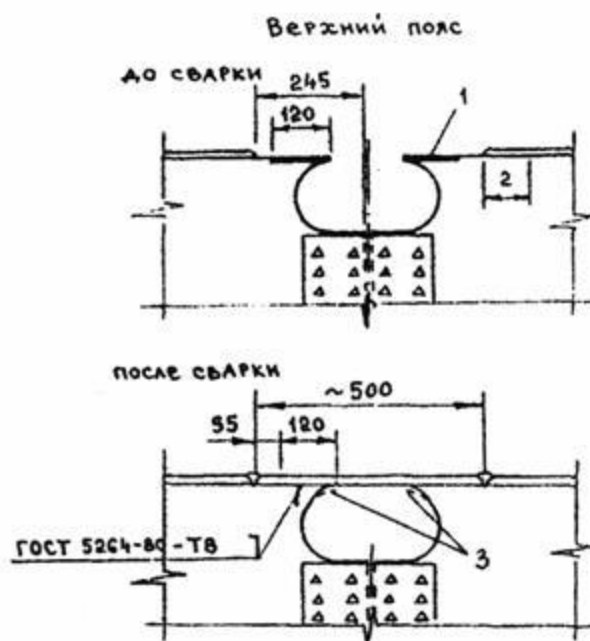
Конструкция и очередность механизированной сварки монтажного стыка главных балок (цифрами обозначена последовательность наложения швов).
